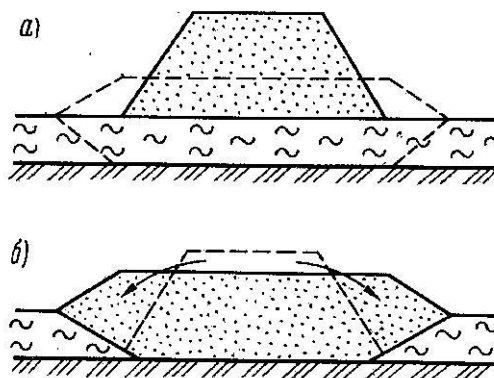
Схемы удаления (выторфовывания) и замены слабых грунтов на стабильные экскаватором
